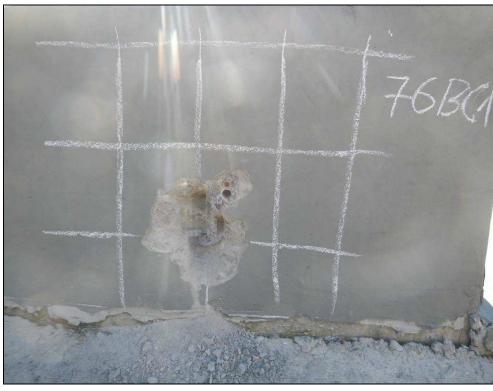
Вскрытие арматуры конструкции стены СТ-76
